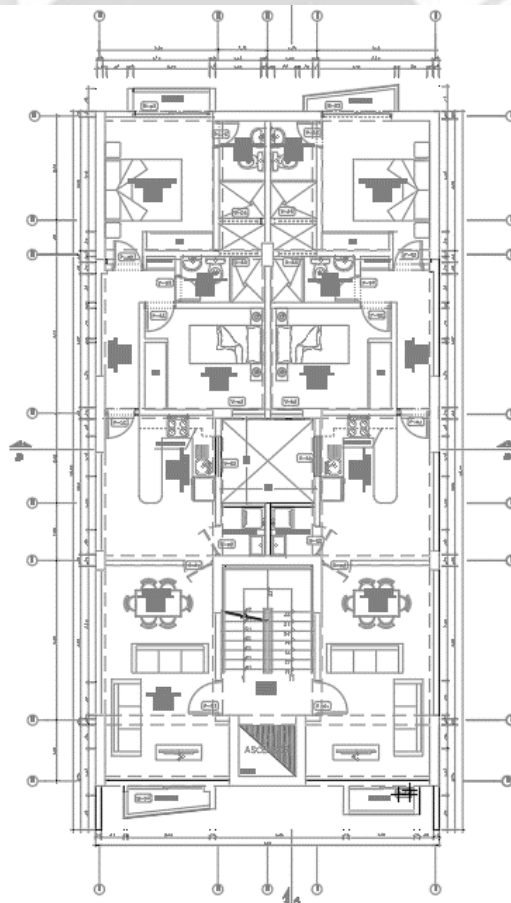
La distribución arquitectónica de la planta típica del edificio
